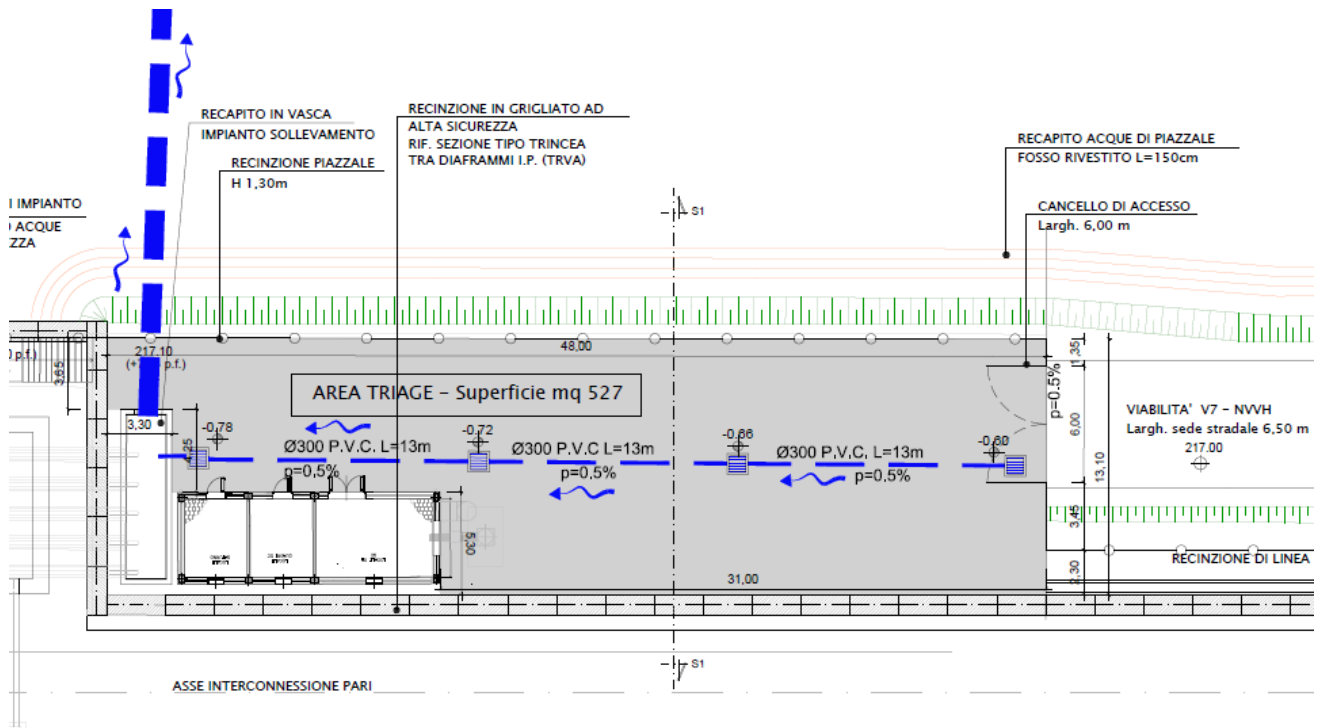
Progetto approvato – piazzale INVD - Pianta
